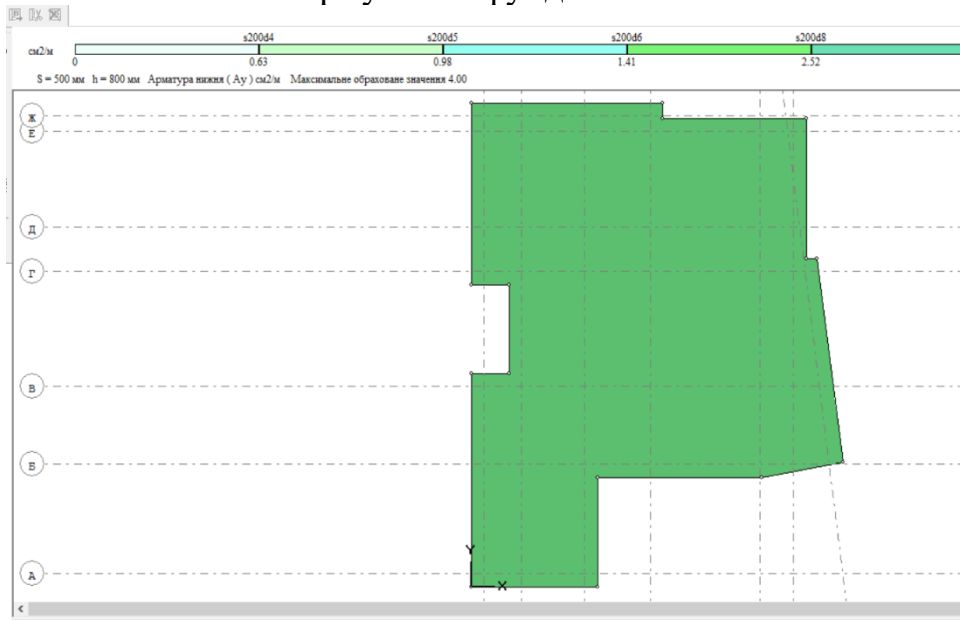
Нижнє армування фундаментної плити по осі Х
